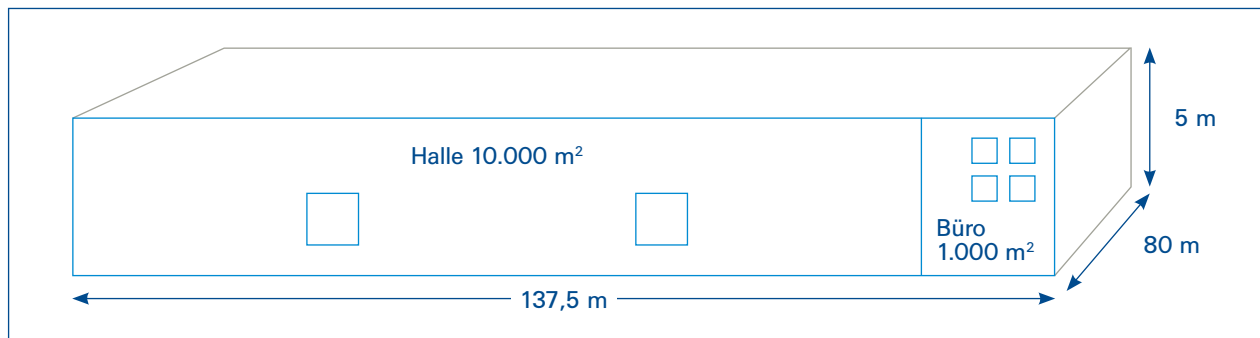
Logistikhalle, Ausstattungsklasse C (Quelle: IndustrialPort)
